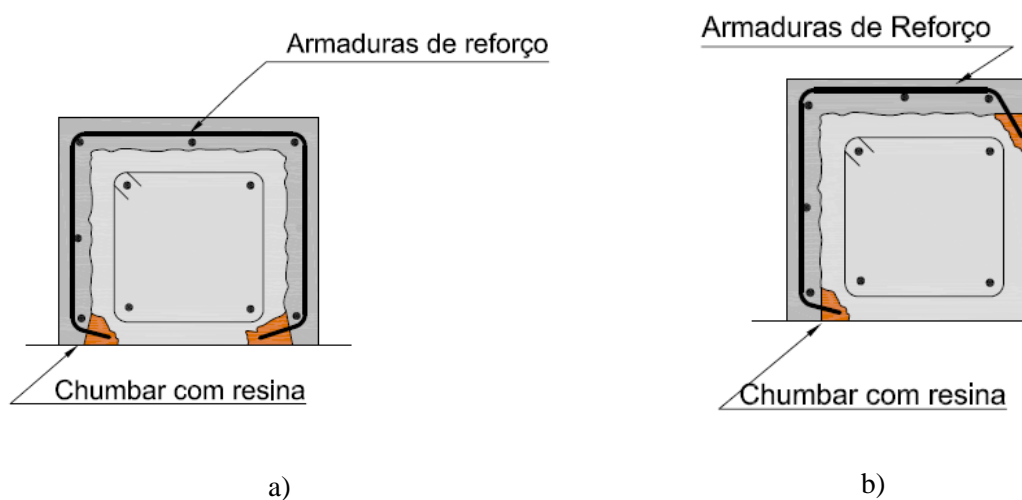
Configurações especiais. a) Pilar de fachada; b) Pilar de canto.
